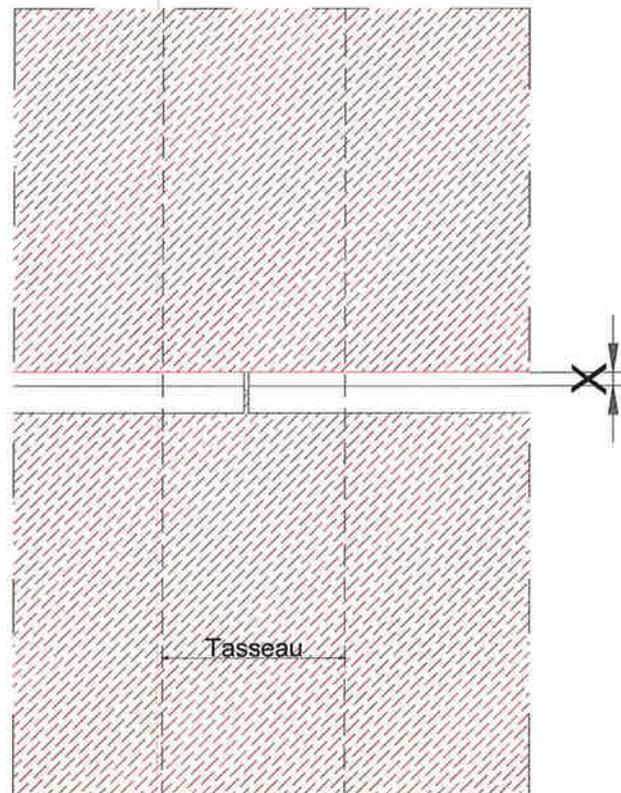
Aboutage des profilés de fermeture des joints horizontaux sur tasseau pour MOB supérieure à R+2
